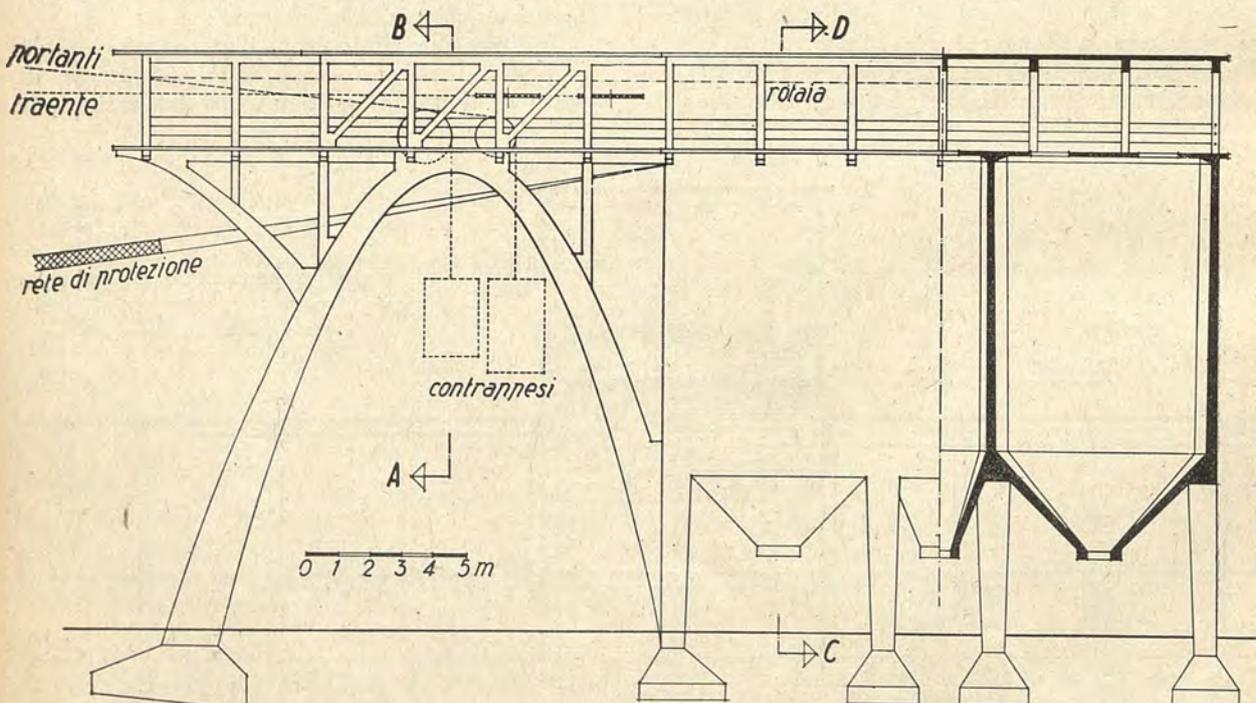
Stazione arrivo (Prospetto e sezione longitudinale).
